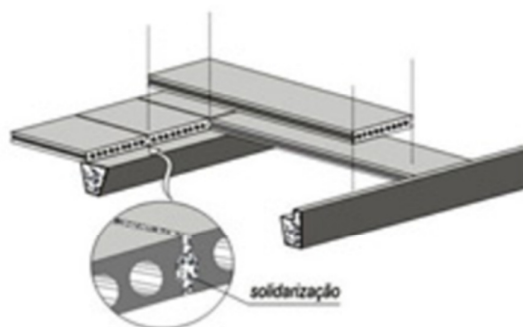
Detalhe de solidarização das lajes (www.galpoesprefabricados.com.br, 2014).
